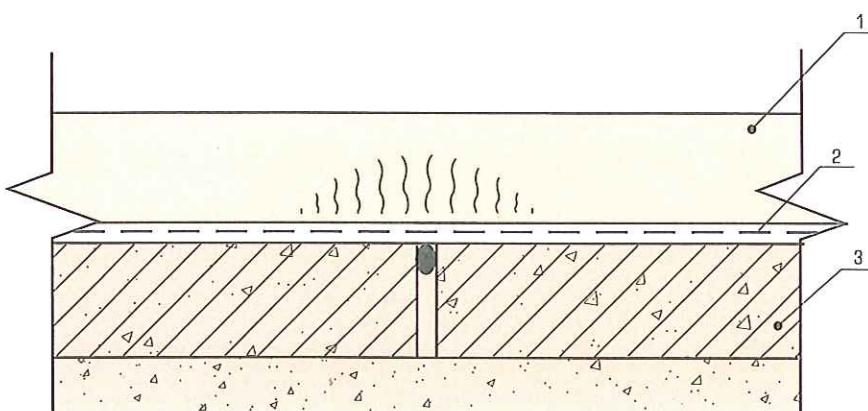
Схема укладки геосетки SamiGrid при усилении цементобетонных покрытий асфальтобетоном:
